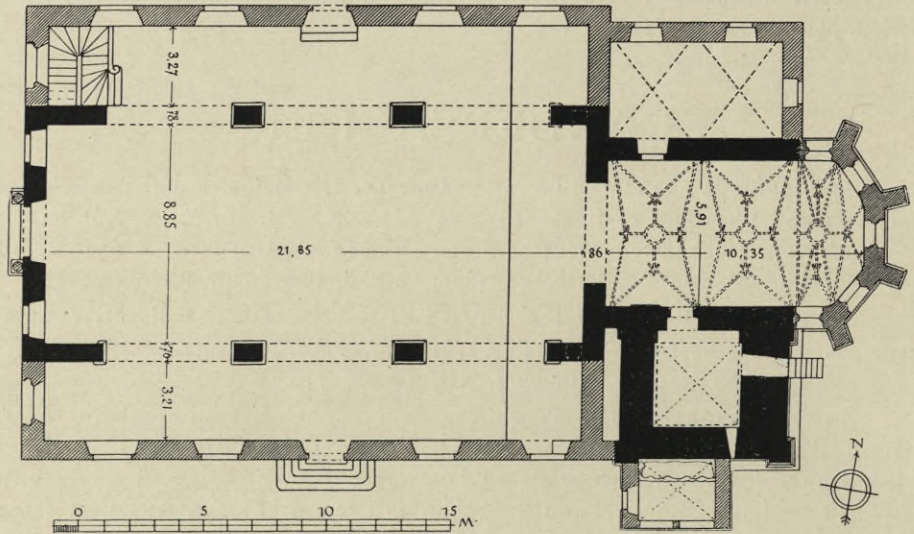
Randersacker. Grundriß der Pfarrkirche.
